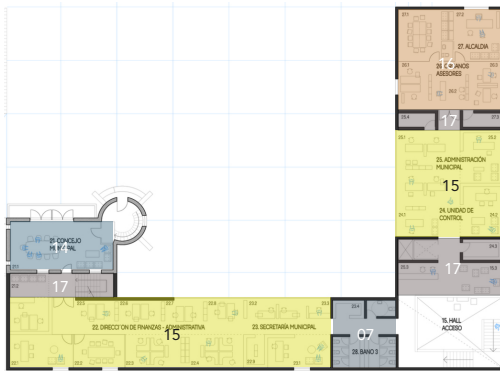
Distribución de áreas planta baja edificio consorsial de Papudo (2015). Fuente: Archdaily Elaborado por el autor
